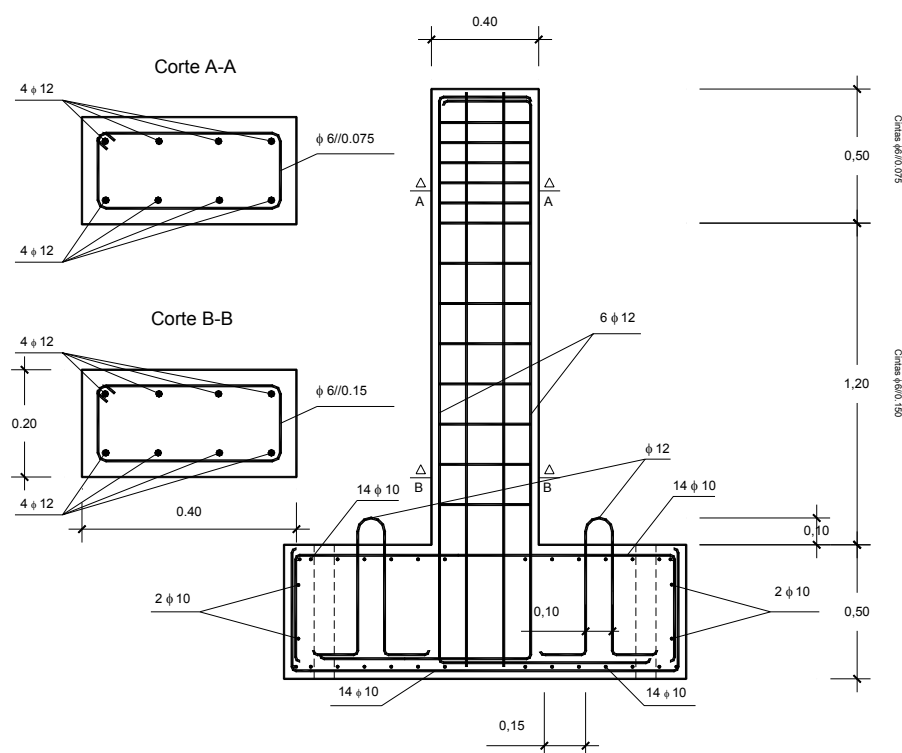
Pormenores da armadura do modelo PA2 (dimensões em m).
